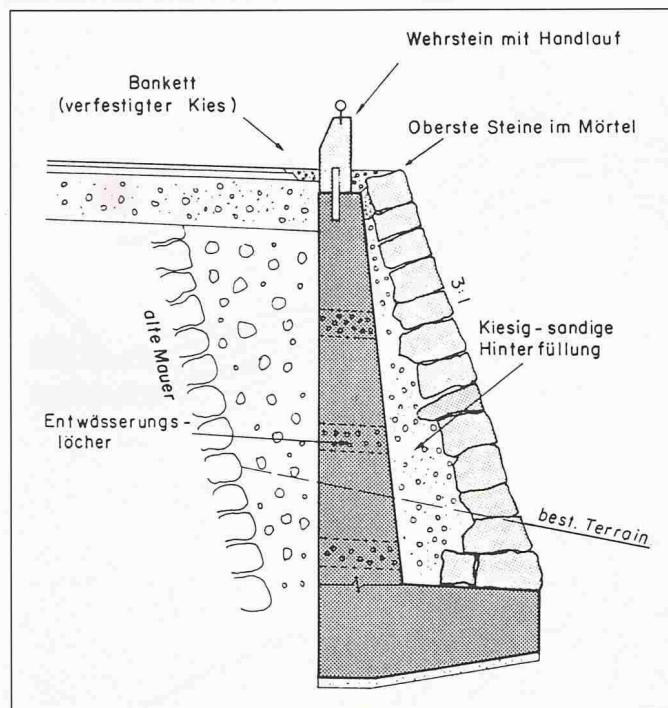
Betonkonstruktion mit vorgelagerter Trockenmauer
